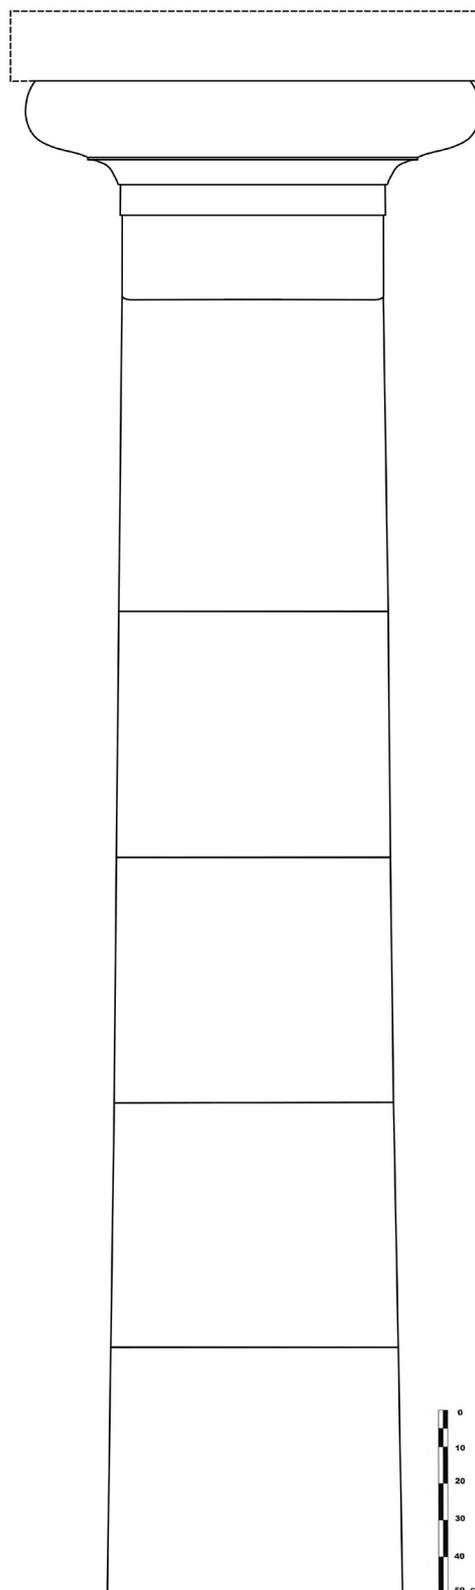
Propuestas de alzado de columna de la *porticus duplex* (dibujo L. Romero).
